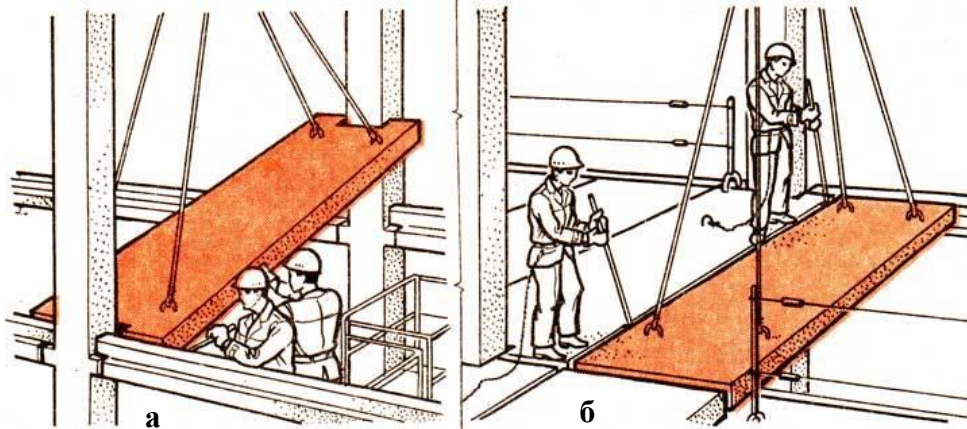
Схема укладання плит перекриття: а – розпірної; б – рядової
